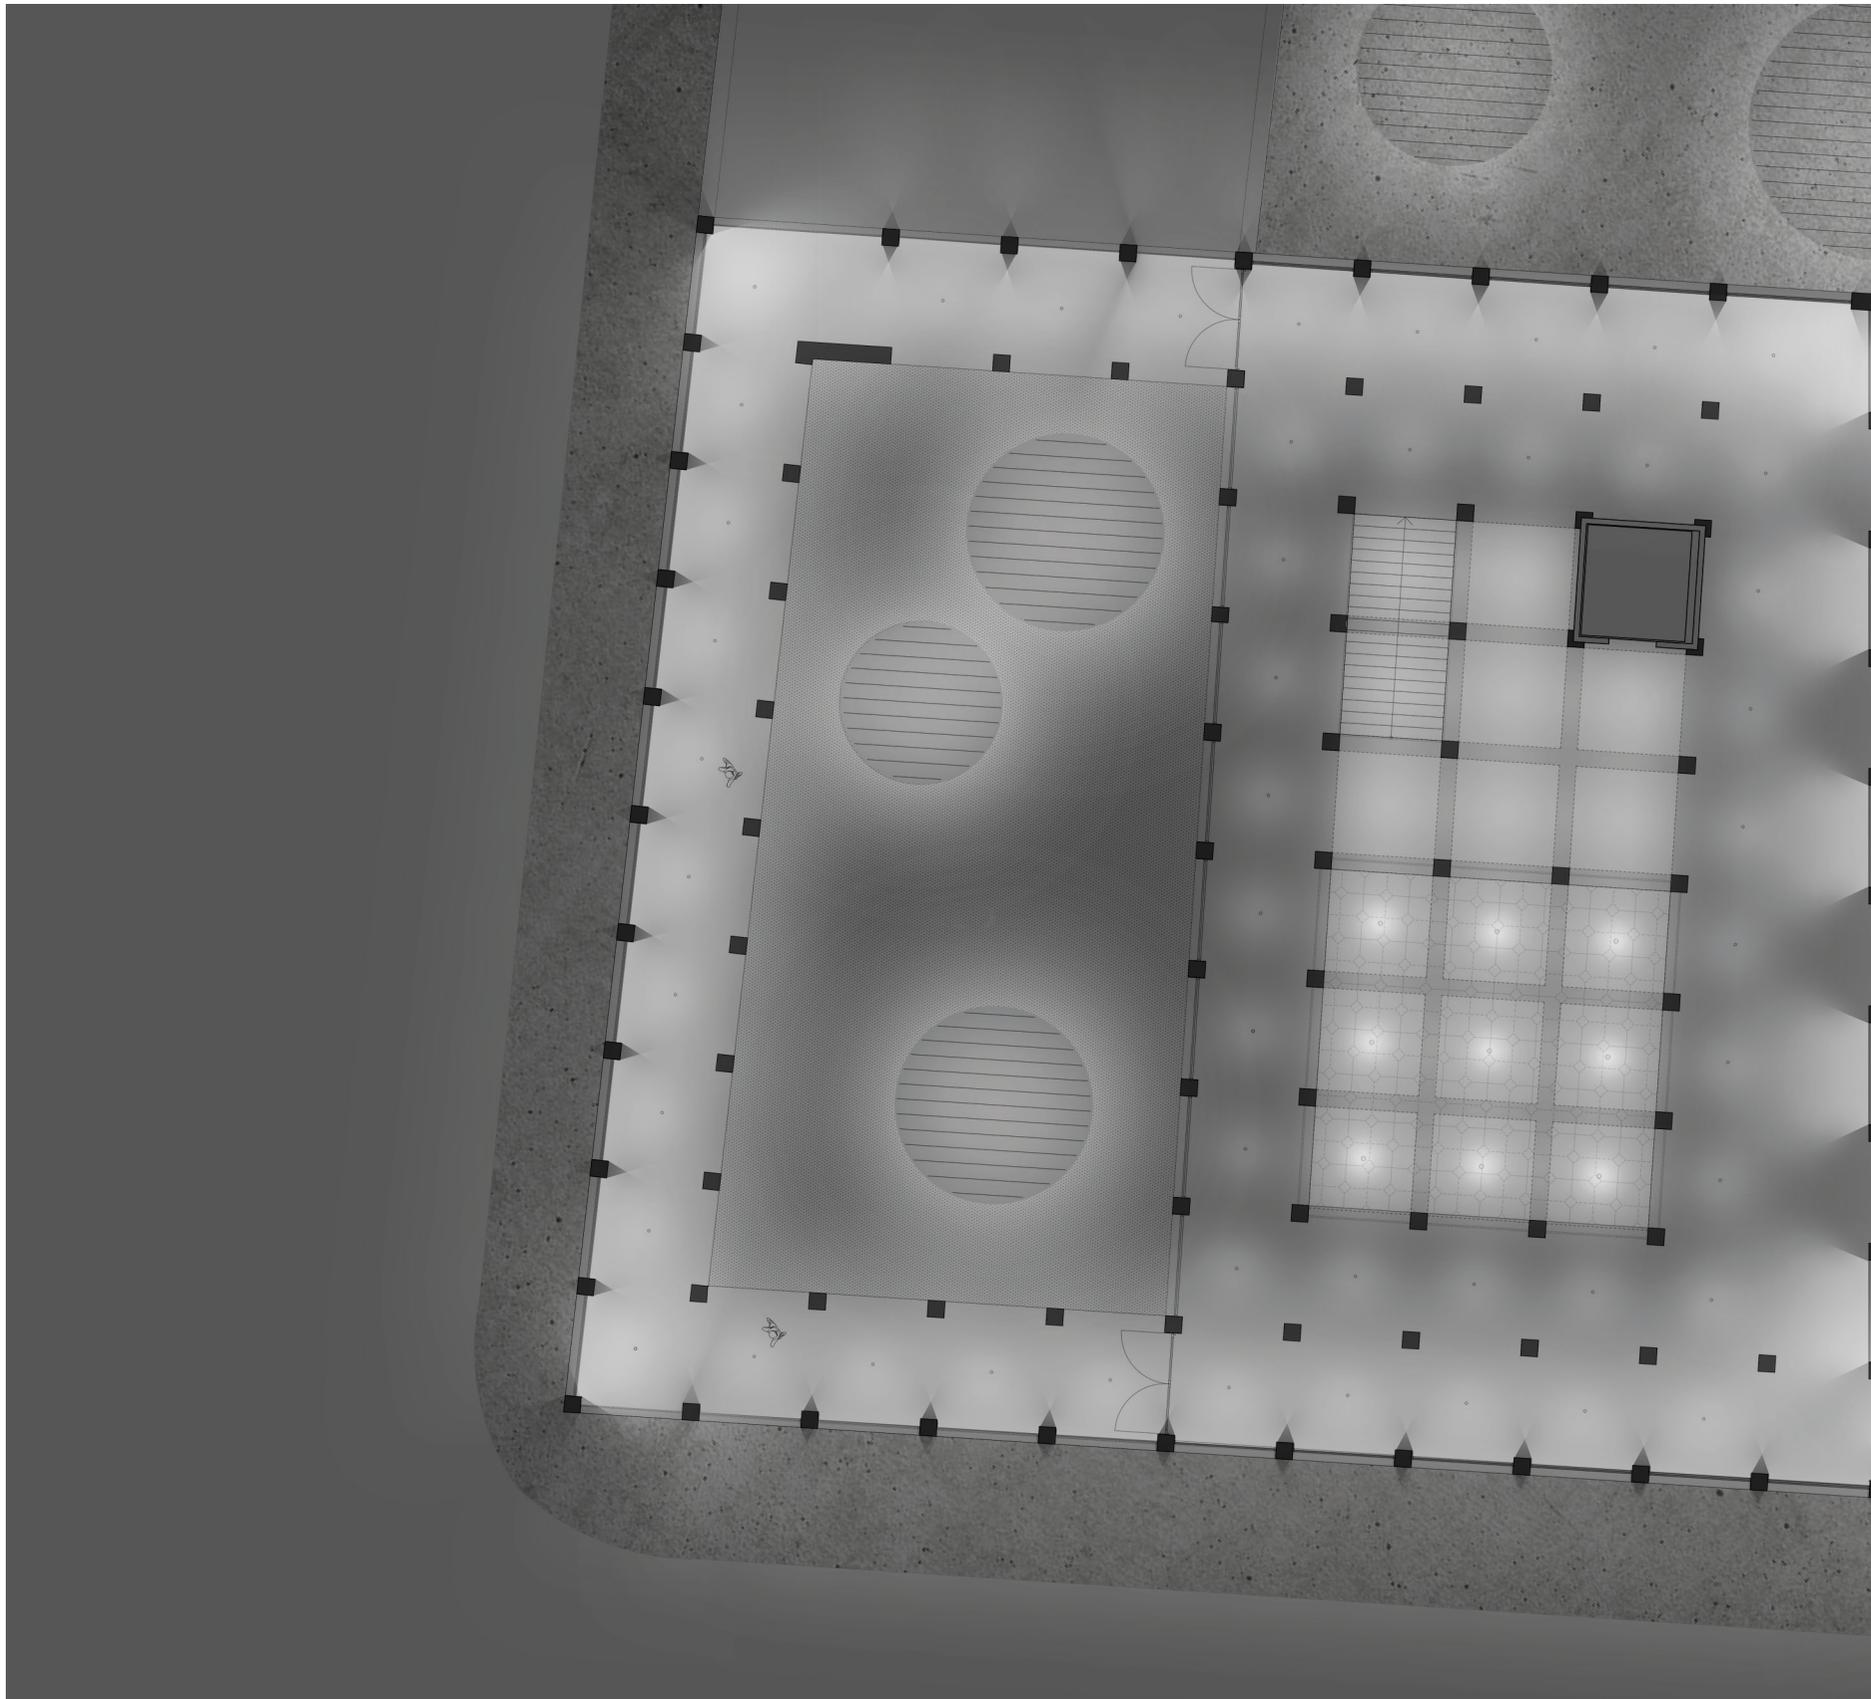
Lichtkonzept Grundriss Ebene 5 | 1:200
